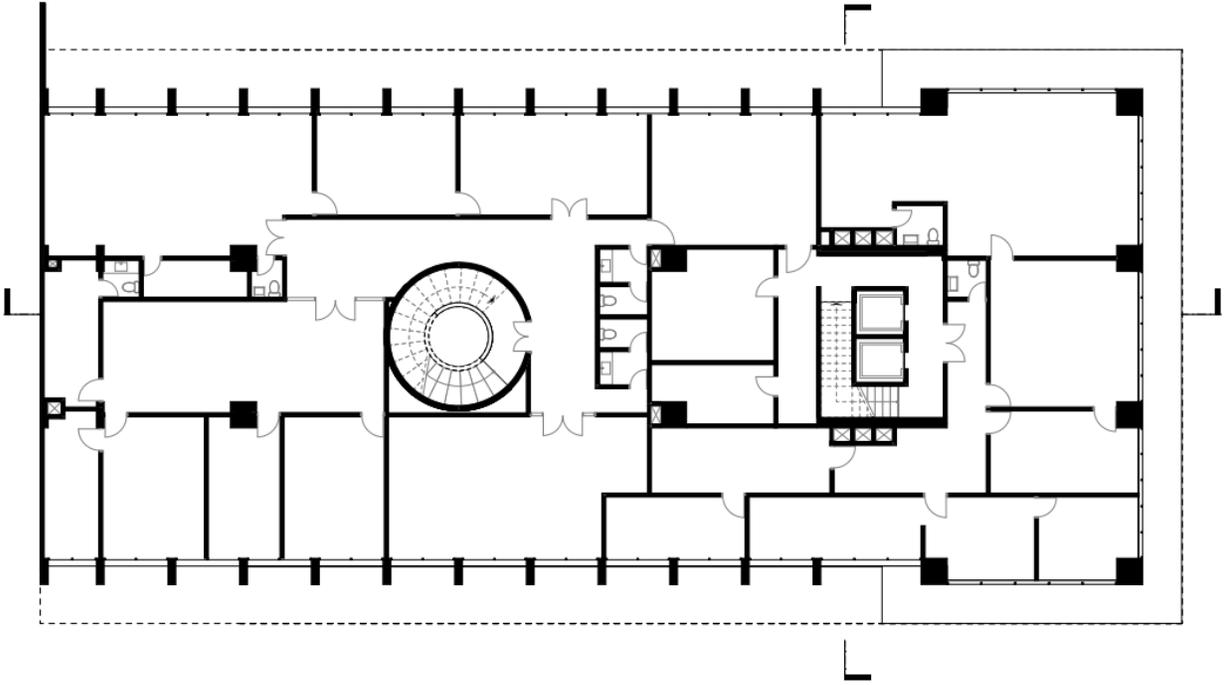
Planta alta actual N+3.40. Fuente: Tesistas.
